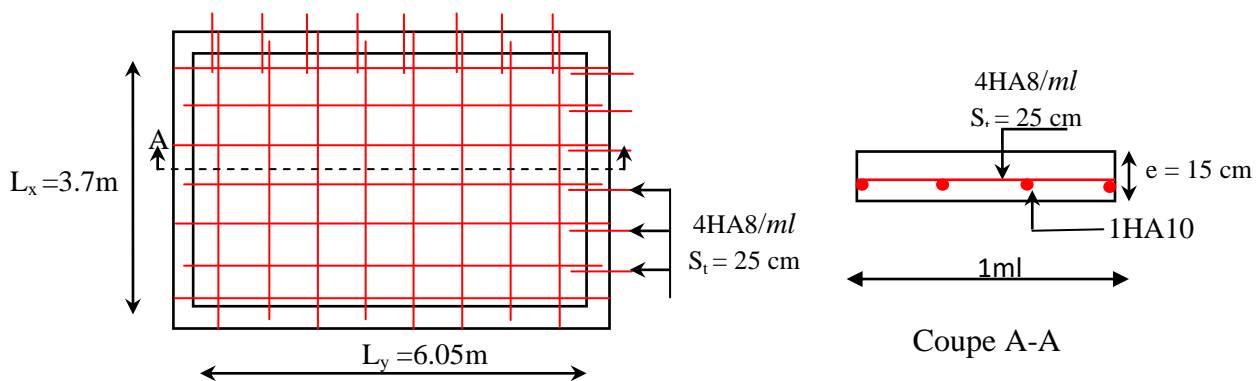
Schéma de ferrailage de la dalle entresol
